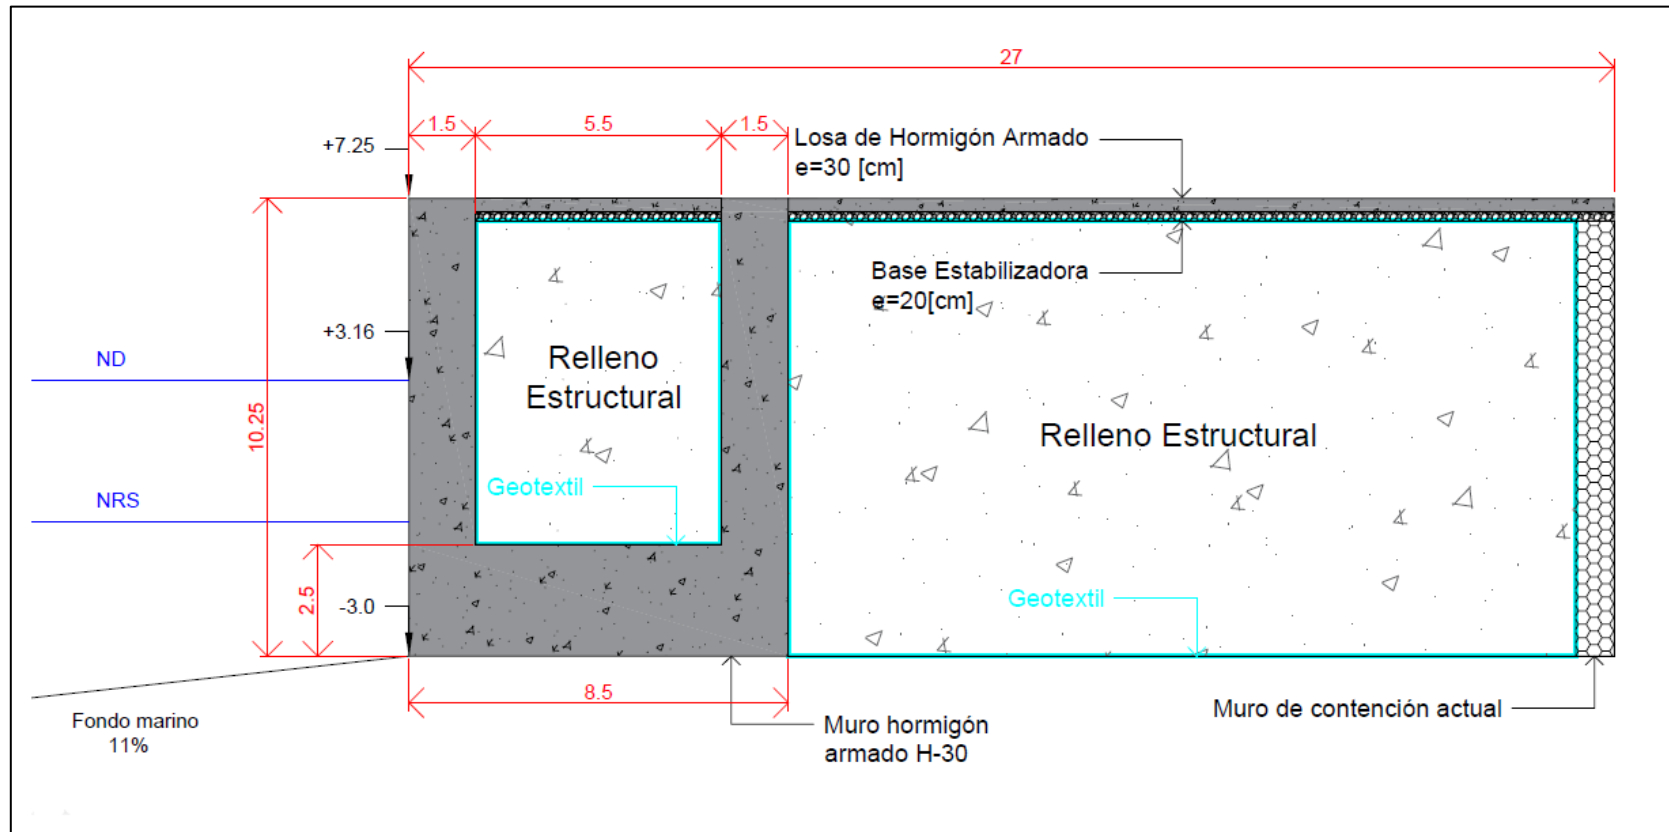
Plano perfil muro gravitacional. Fuente: Elaboración propia en Autocad.
